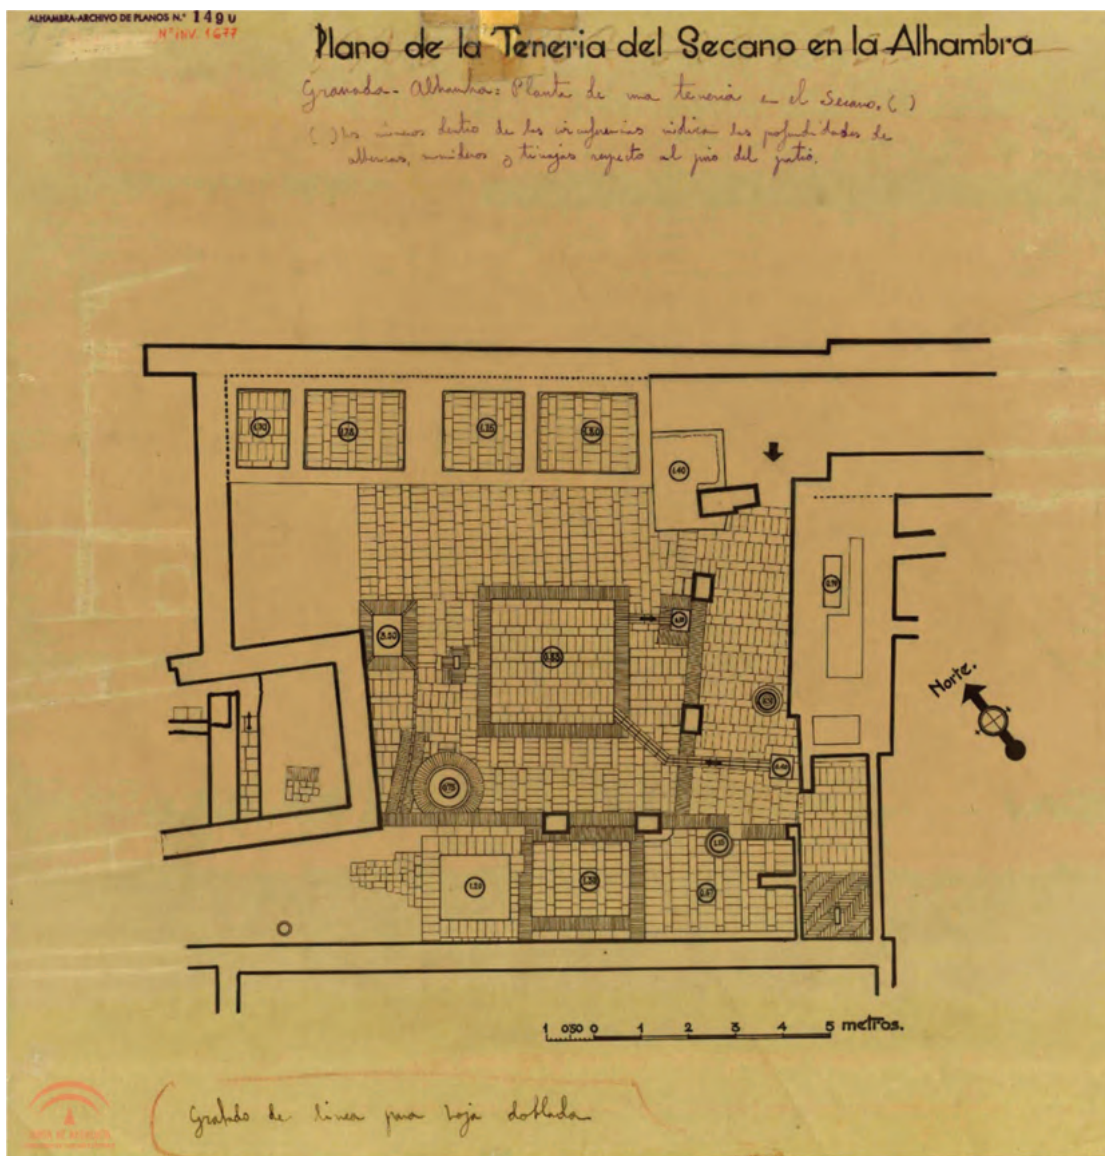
Plano de la tenería del secano de la Alhambra (TORRES, 1935)
